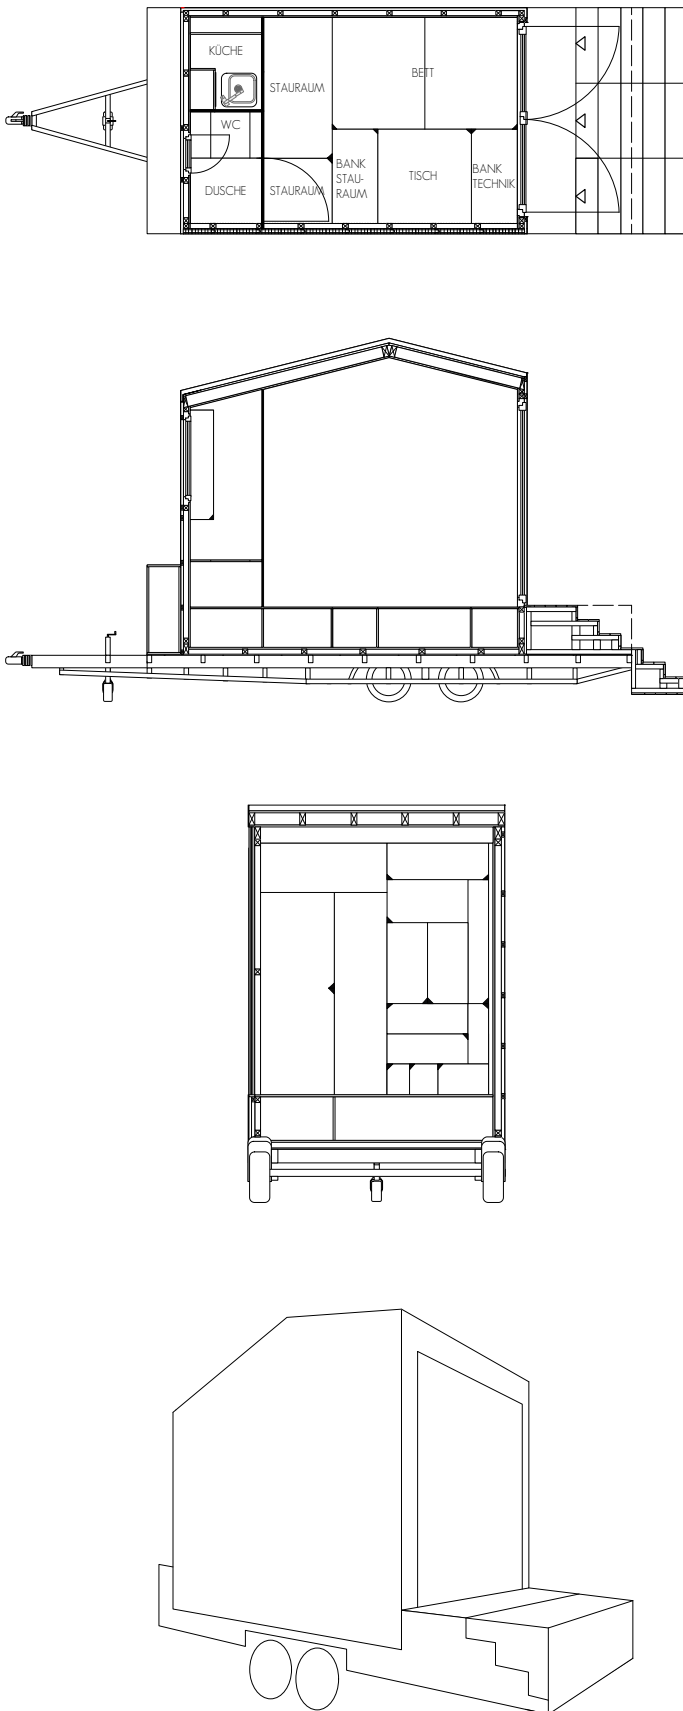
Grundriss, Längs- und Querschnitt, Perspektivische Darstellung
